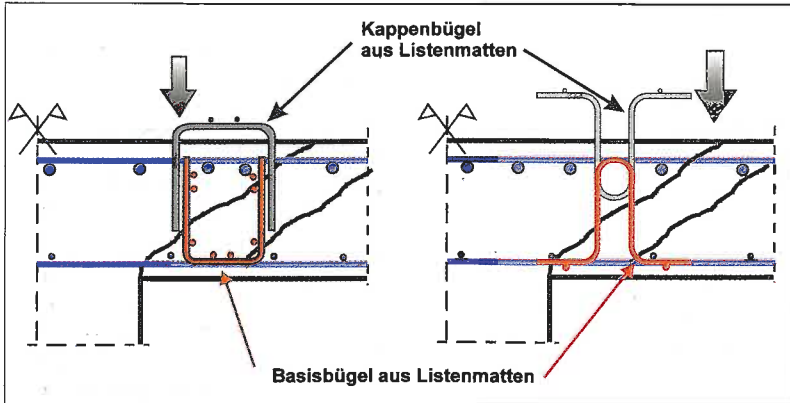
Schubbewehrungsformen I und III aus Listenmatten [8]
